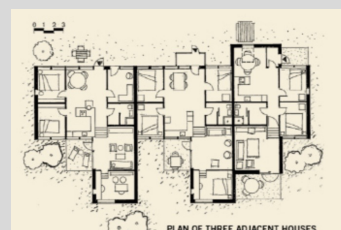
Planta - piso térreo de três habitações adjacentes
